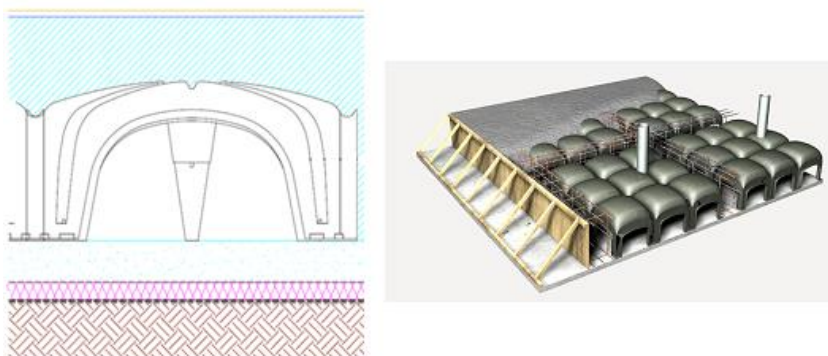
Corte transversal da laje térrea ventilada utilizada na solução da TÉKETO (Téketo, 2012c)
